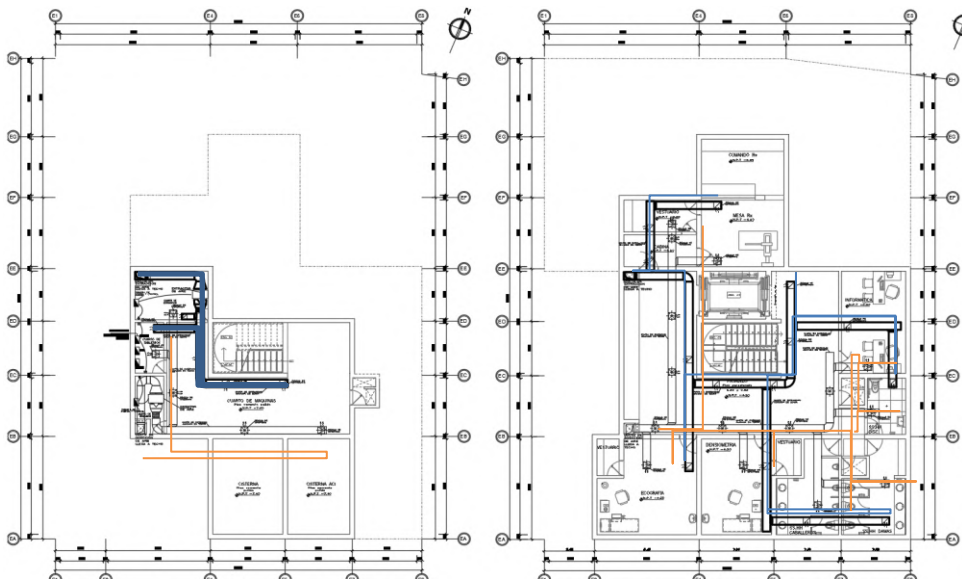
Vista de planta Sótano 02 y Sótano 01, planteamiento de instalaciones Mecánicas
